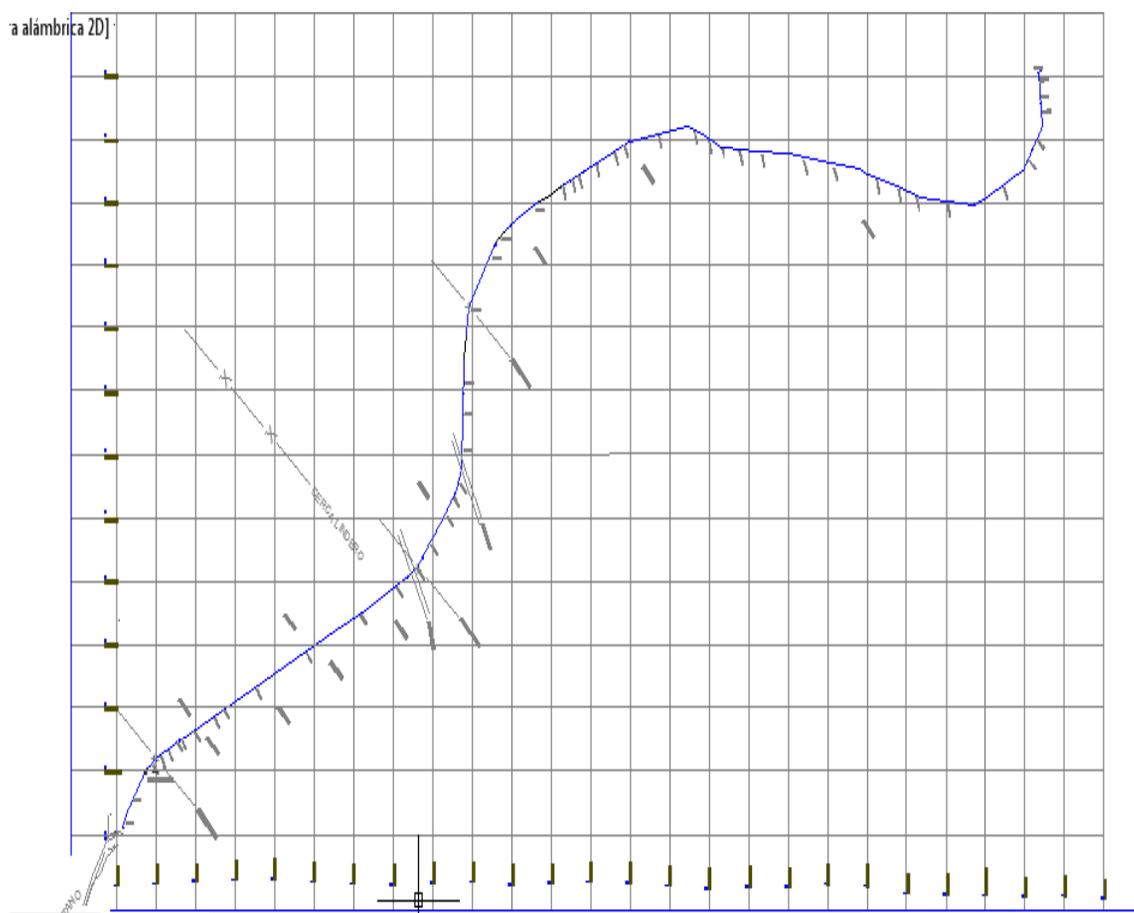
Esquema en planta de la línea de aducción bocatomas-desarenador-tanque.
